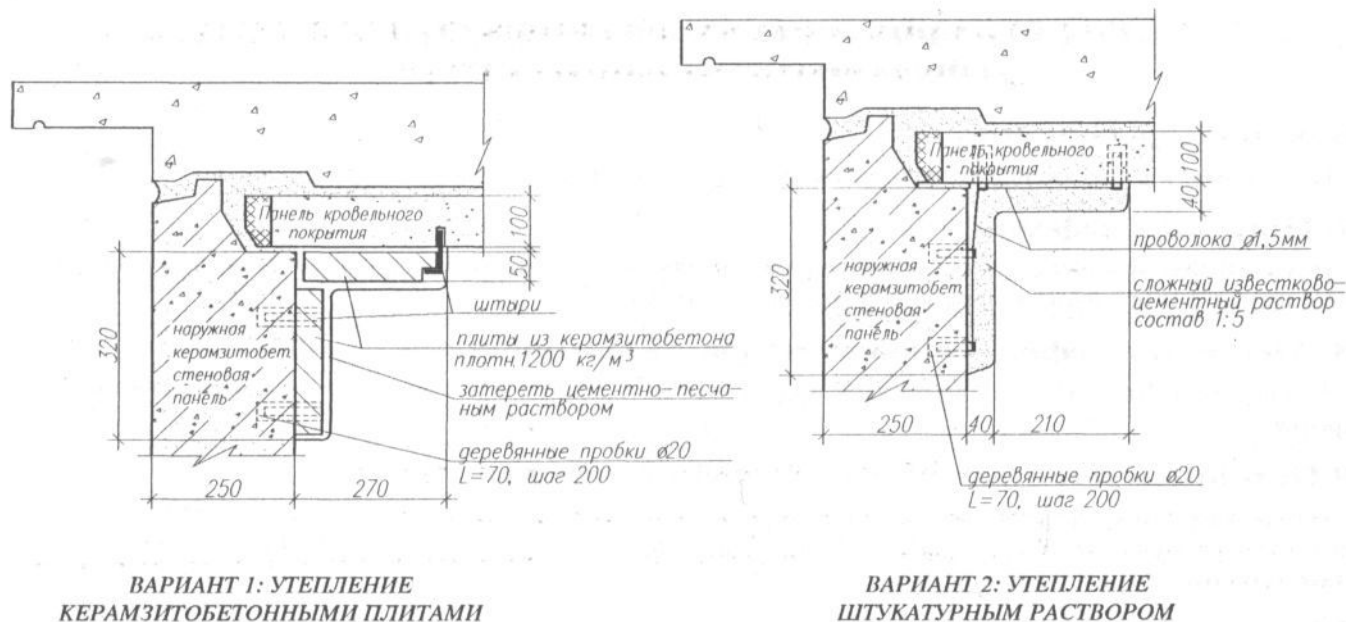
Утепление сопряжений панелей наружных стен с панелями совмещенных крыш
